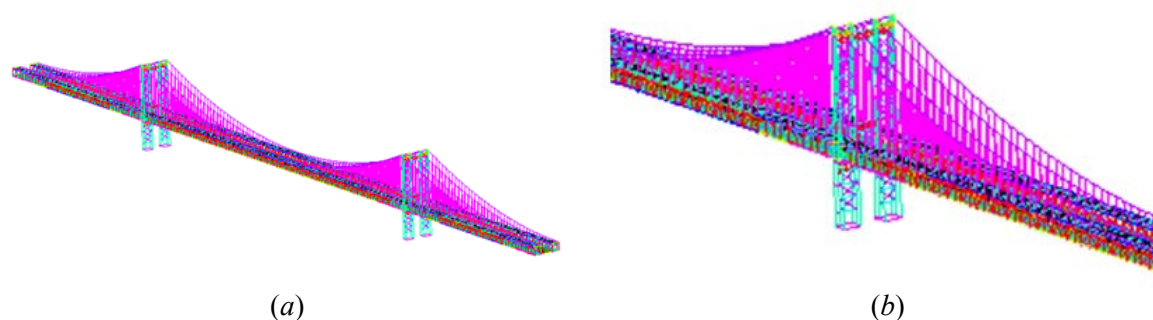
Manhattan Bridge - modello globale a elementi finiti del ponte (a) e dettaglio sulla modellazione delle torri (b).
